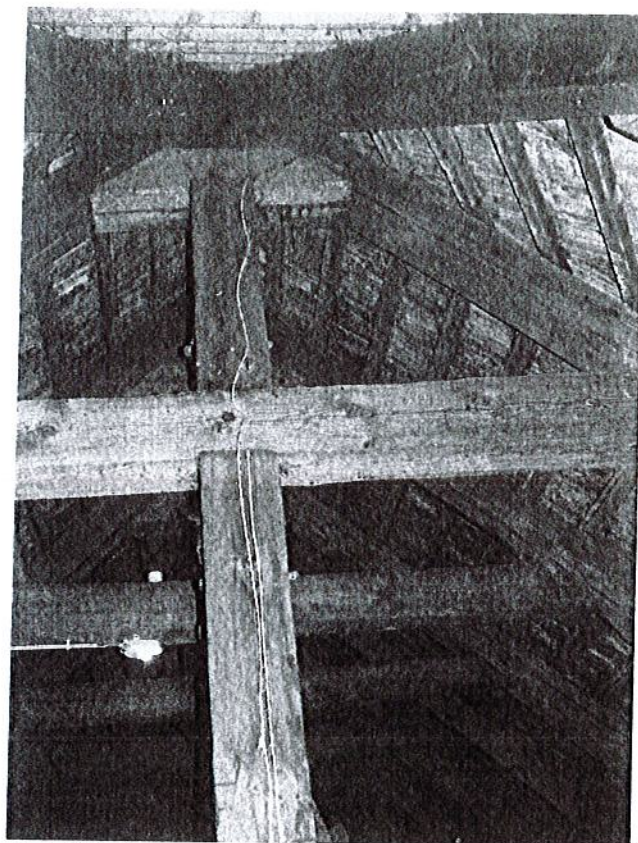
Konstrukcja wieży (widok dachu namiotowego)
